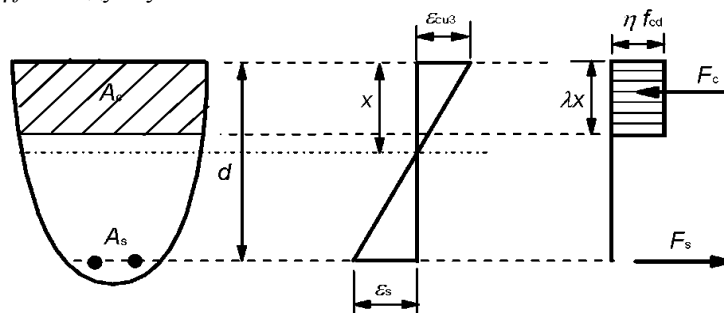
Равномерное распределение напряжений по высоте эффективной сжатой зоны бетона нормального сечения
